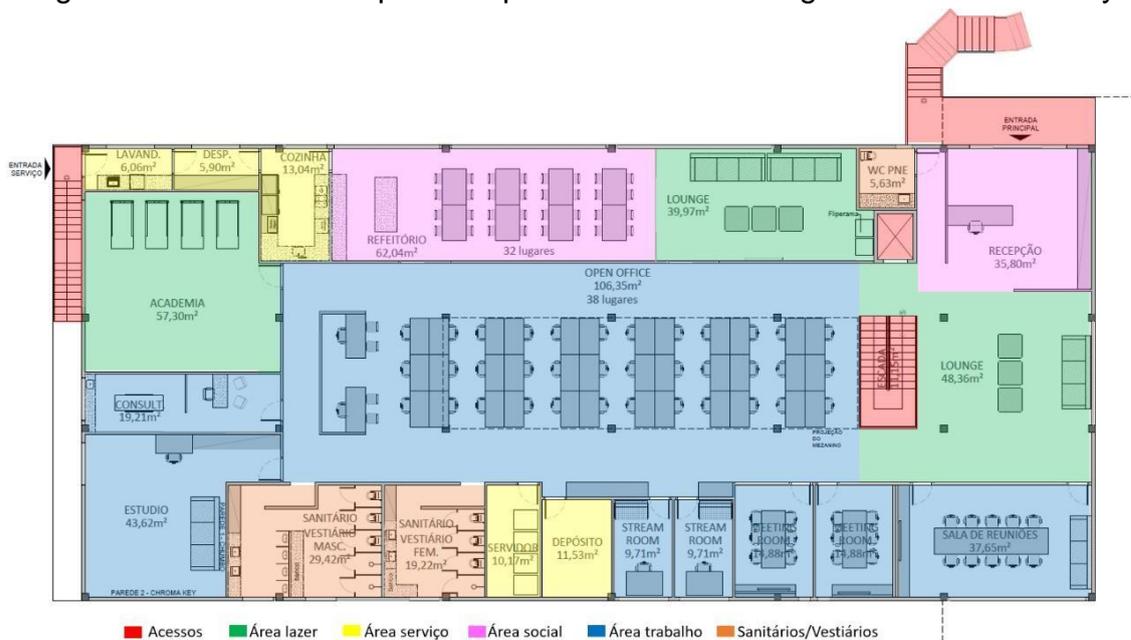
Planta baixa térreo da Gaming Office Havan Liberty
